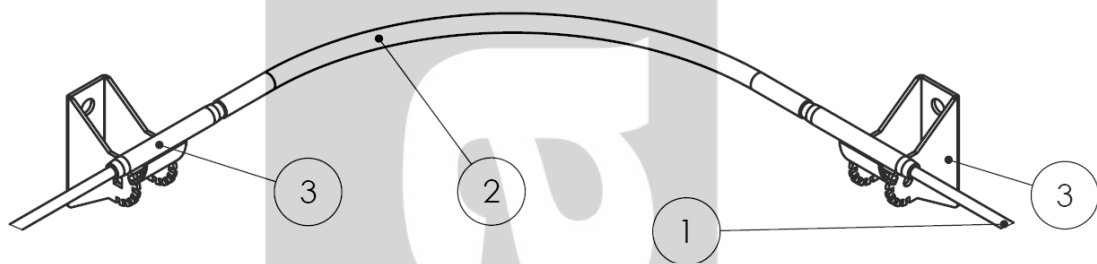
Montaje del sistema en esquinas o cambios de dirección sobre una pared. 1- cable; 2- pieza/tubo de giro de R250 o R300mm., 3- punto de anclaje estructural intermedio.
